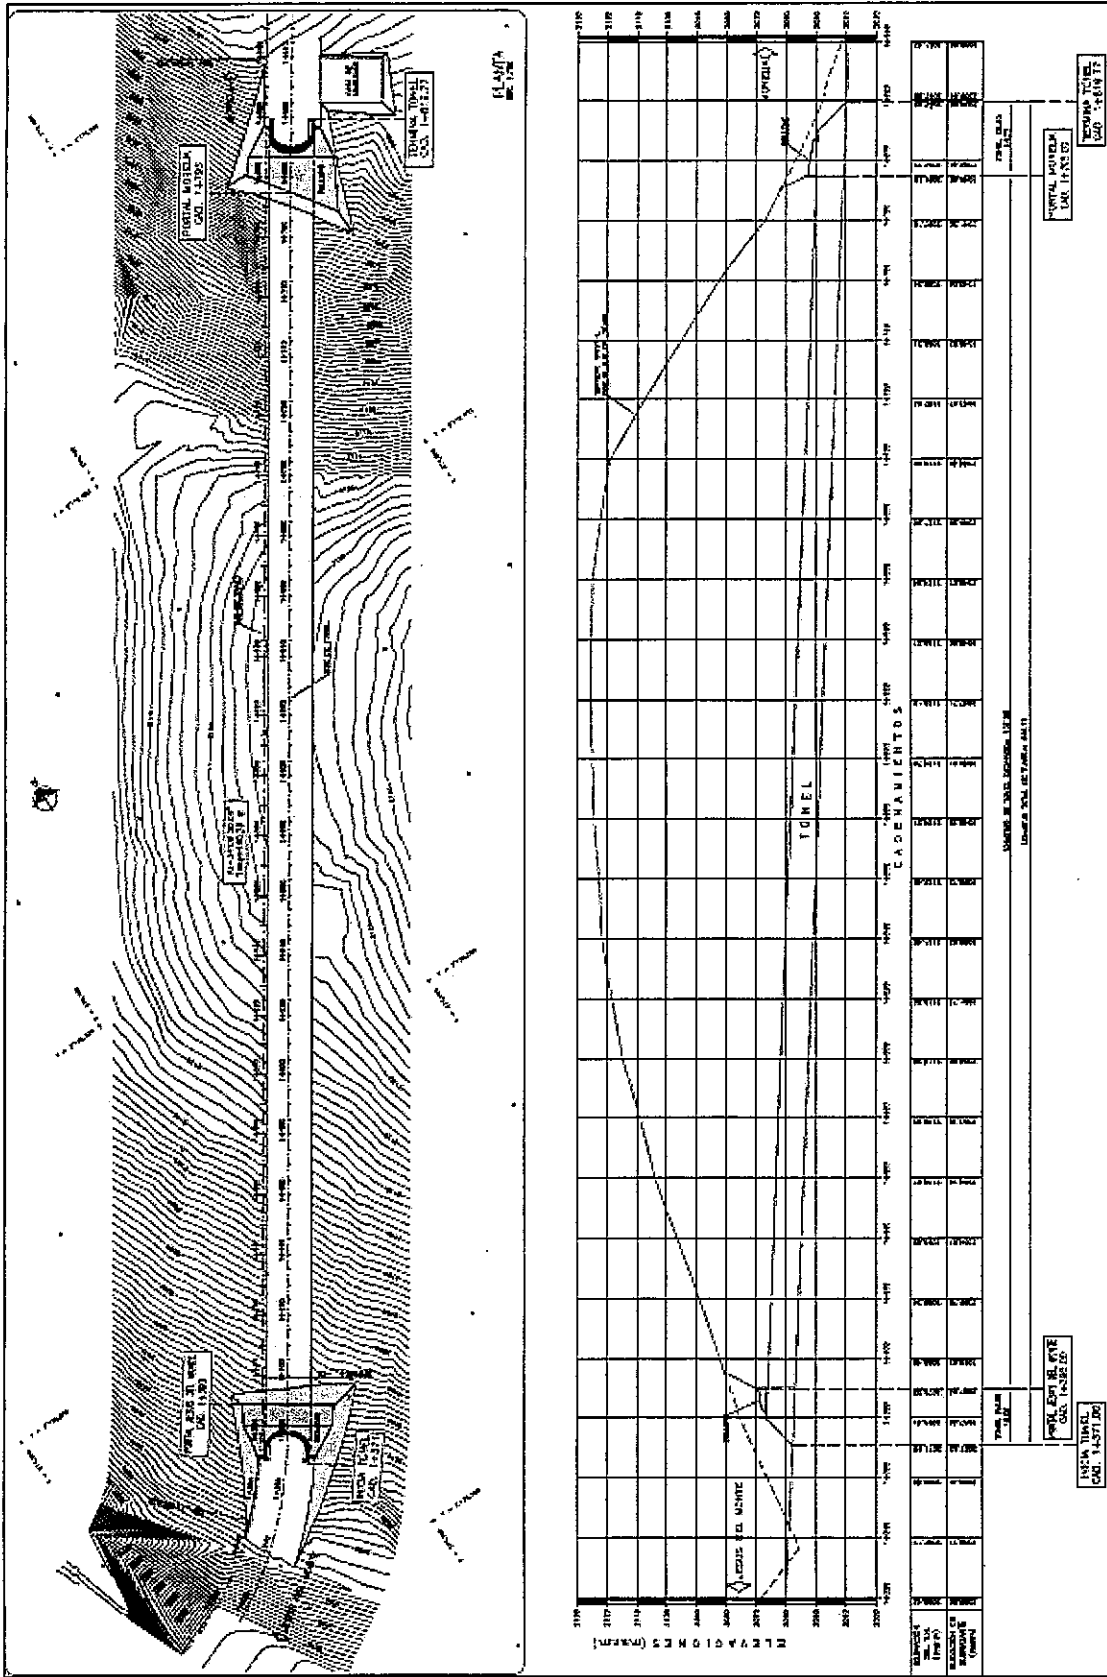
Planta topográfica y perfil longitudinal del Túnel I (Consultec, 2011)
